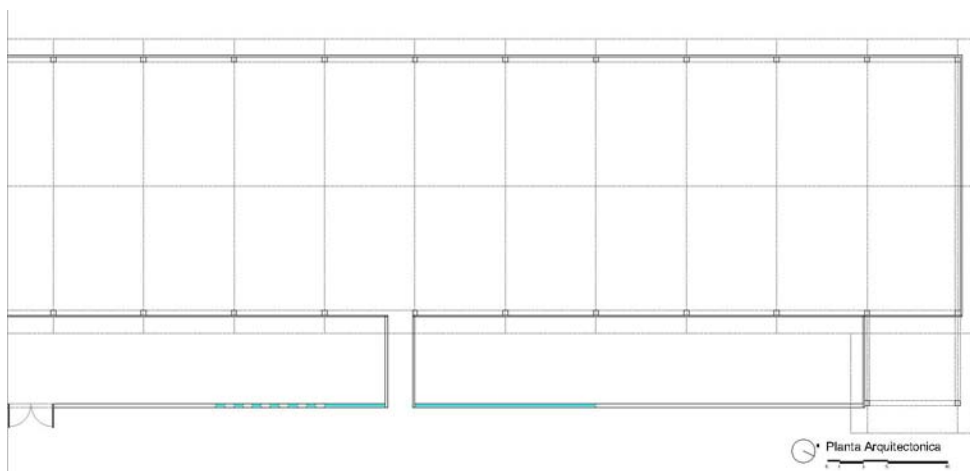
Planta arquitectónica de la nave principal. Dibujo: Luis Manuel Chacón
